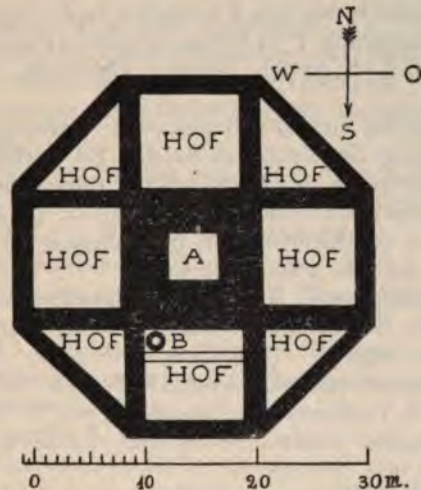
Rekonstruierter Grundriss der untern Burg zu Küssnacht.
